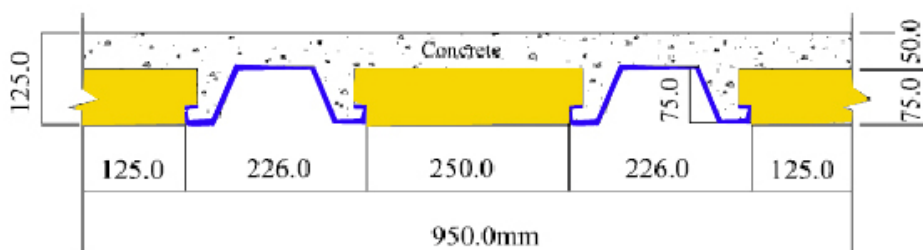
Sistema de laje mista idealizada . Fonte: Andrade et al. (2004)
